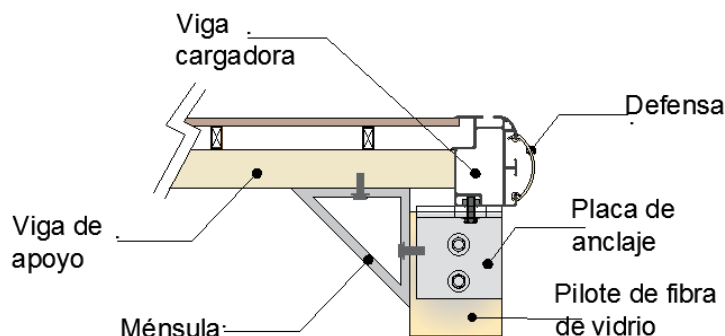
Detalle 4 (D4-) Union de cubierta a pilote
